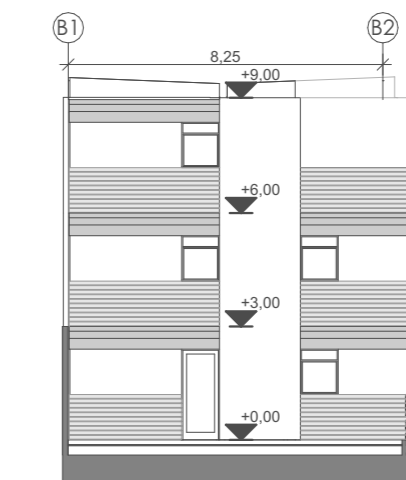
Alzado lateral derecho del Bloque B (BD) Elaboración propia (2026). Escala 1:200
